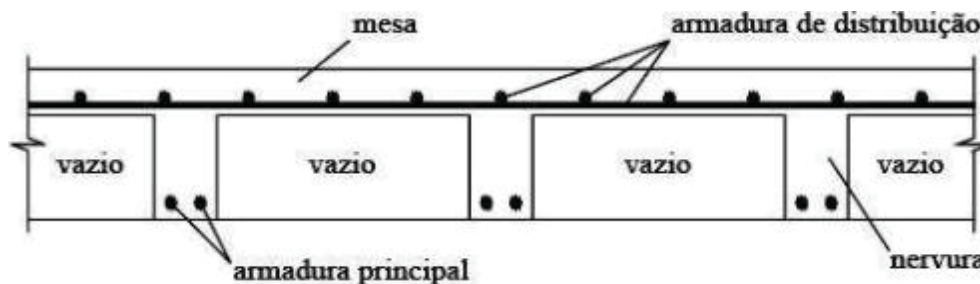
Armaduras na laje segundo www.ufrgs.br
